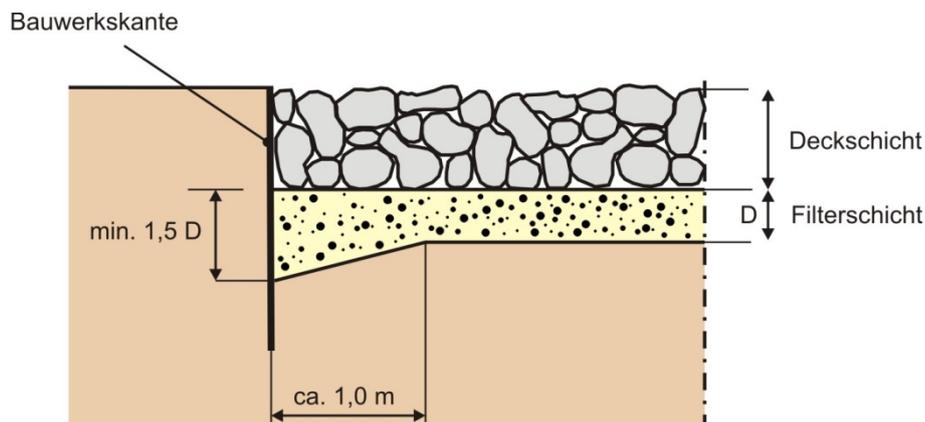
Anschluss eines Deckwerks mit Kornfilter an eine vertikale Bauwerkskante
